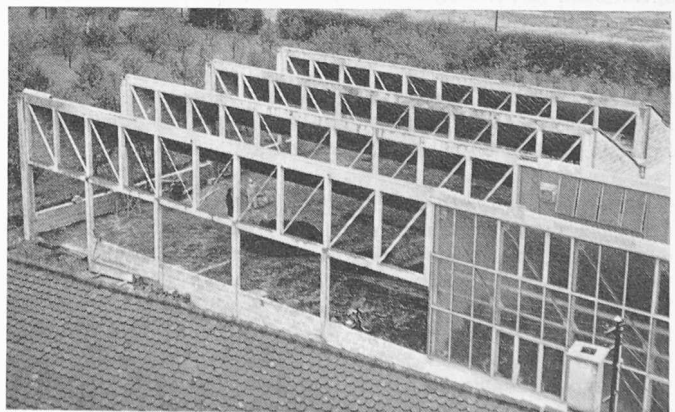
Sheddalle mit Fachwerkbindern in der Fensterfläche
